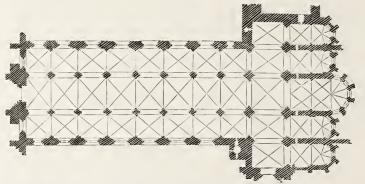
Grundriß der Klosterkirche zu Batalha.
